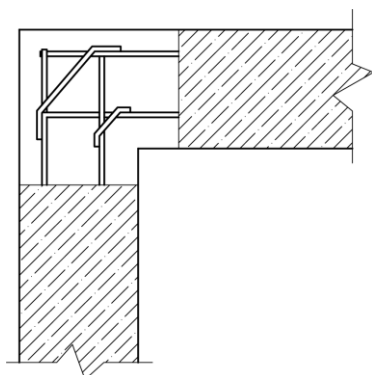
Прямоугольный сборный резервуар
